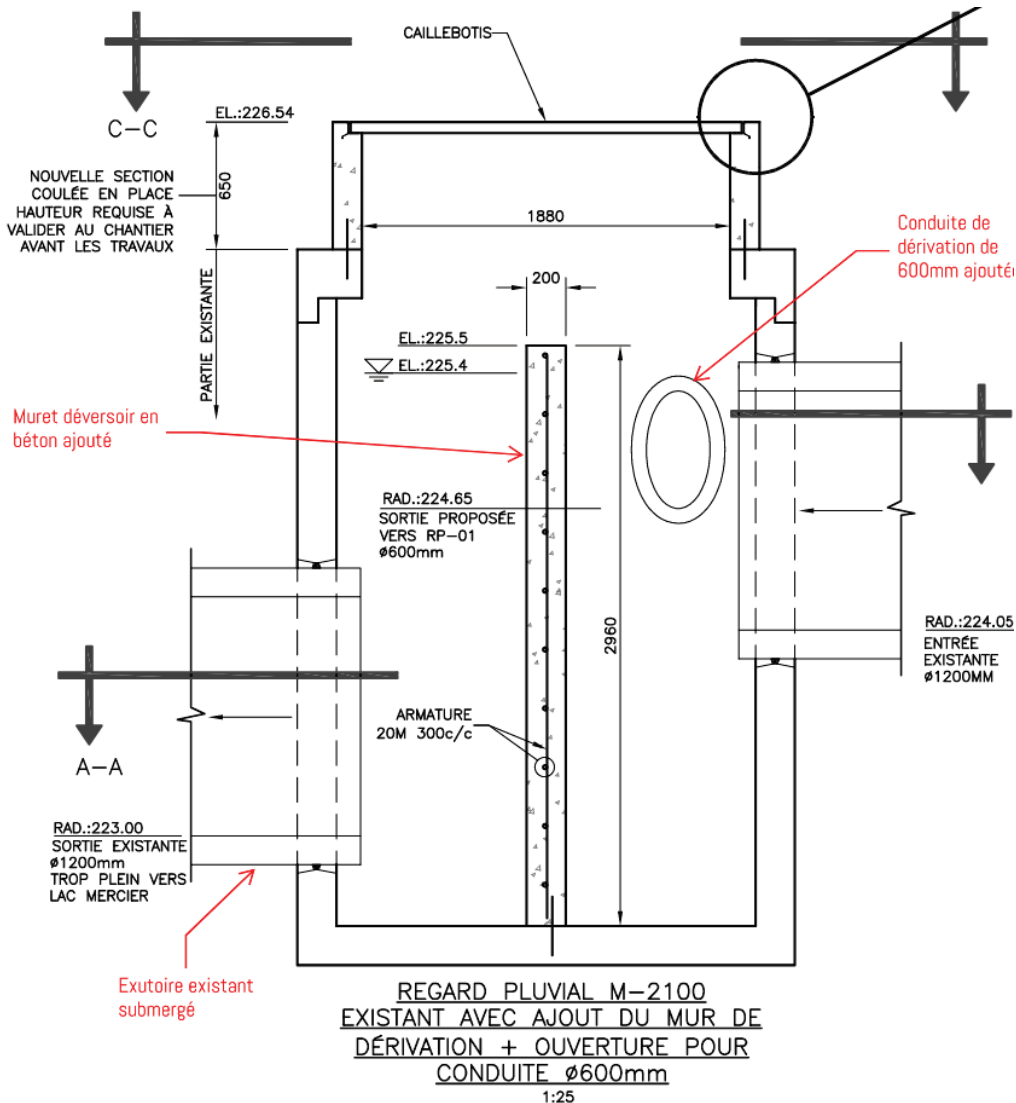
Détail du muret déversoir et conduite de dérivation (Extrait des plans de Marchand Houle & Associés, 2010)
